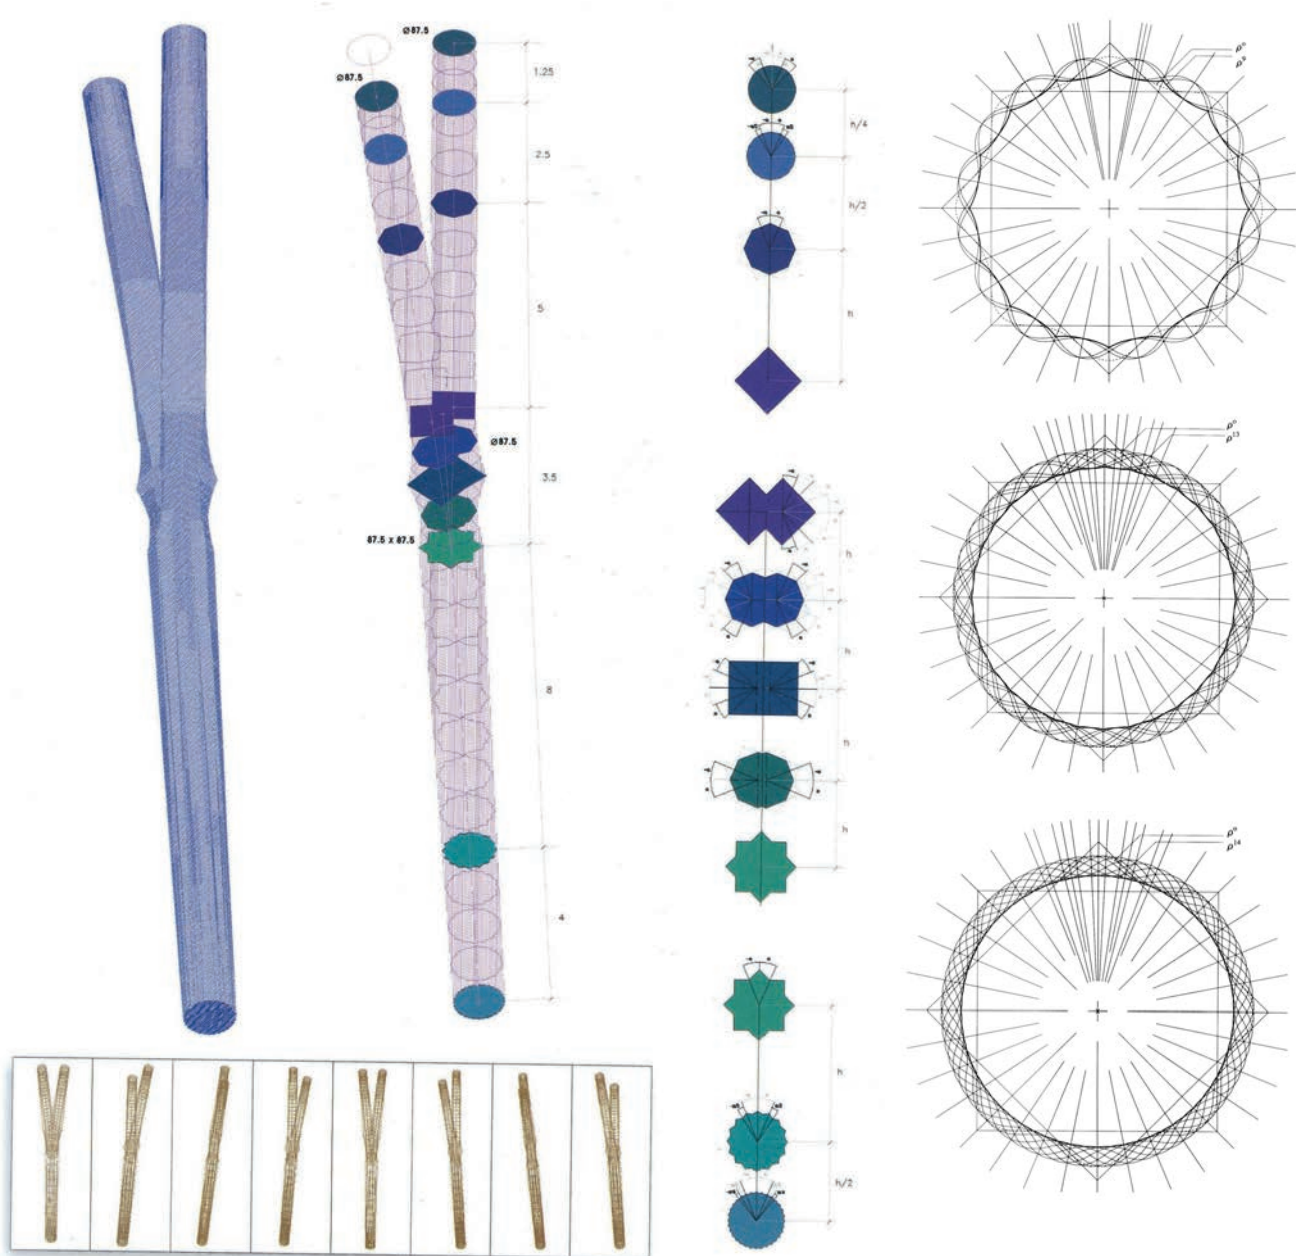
Mecanismo de generación de las columnas del templo, concretamente de la columna de 8 aristas, y de su bifurcación
